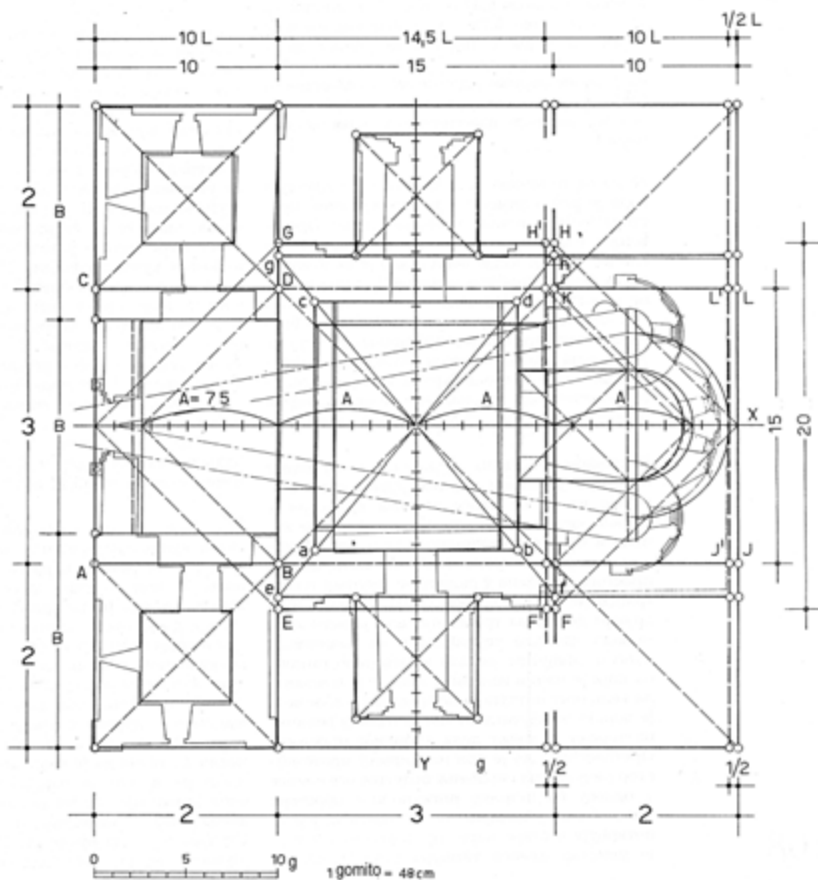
San Giorgio, pianta con schema delle proporzioni (da Nešković 1984)
